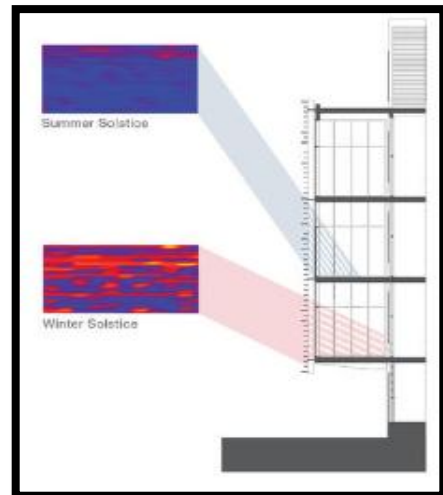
photo prise par une caméra thermique de la façade sud-ouest
